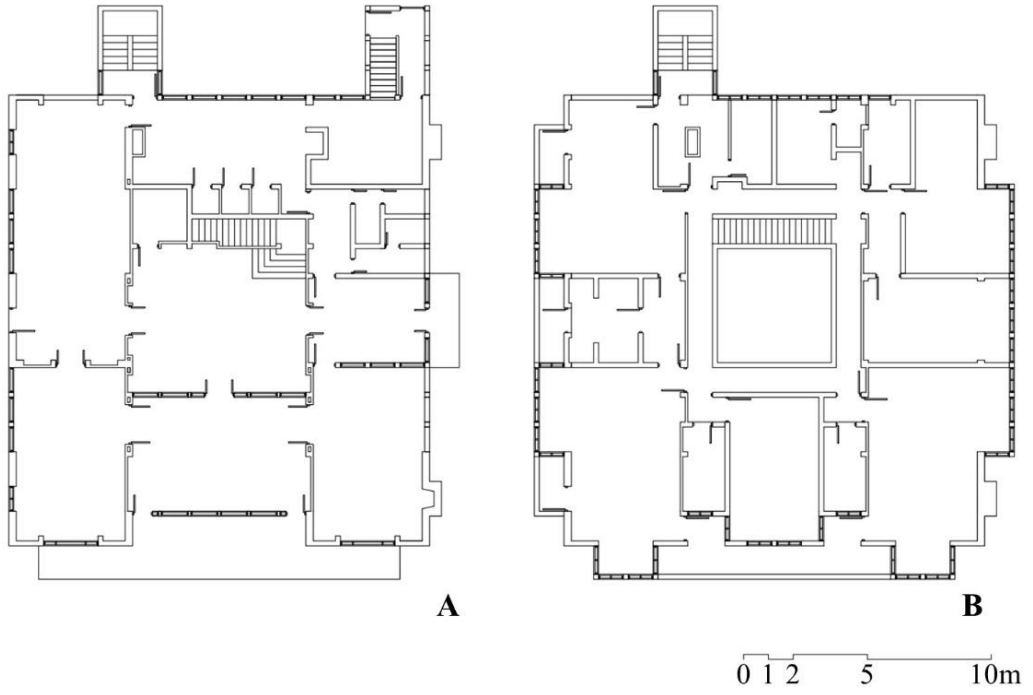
Pakistan Büyükelçilik Konutu, kat planları. A) Alt kat planı B) Üst kat planı
